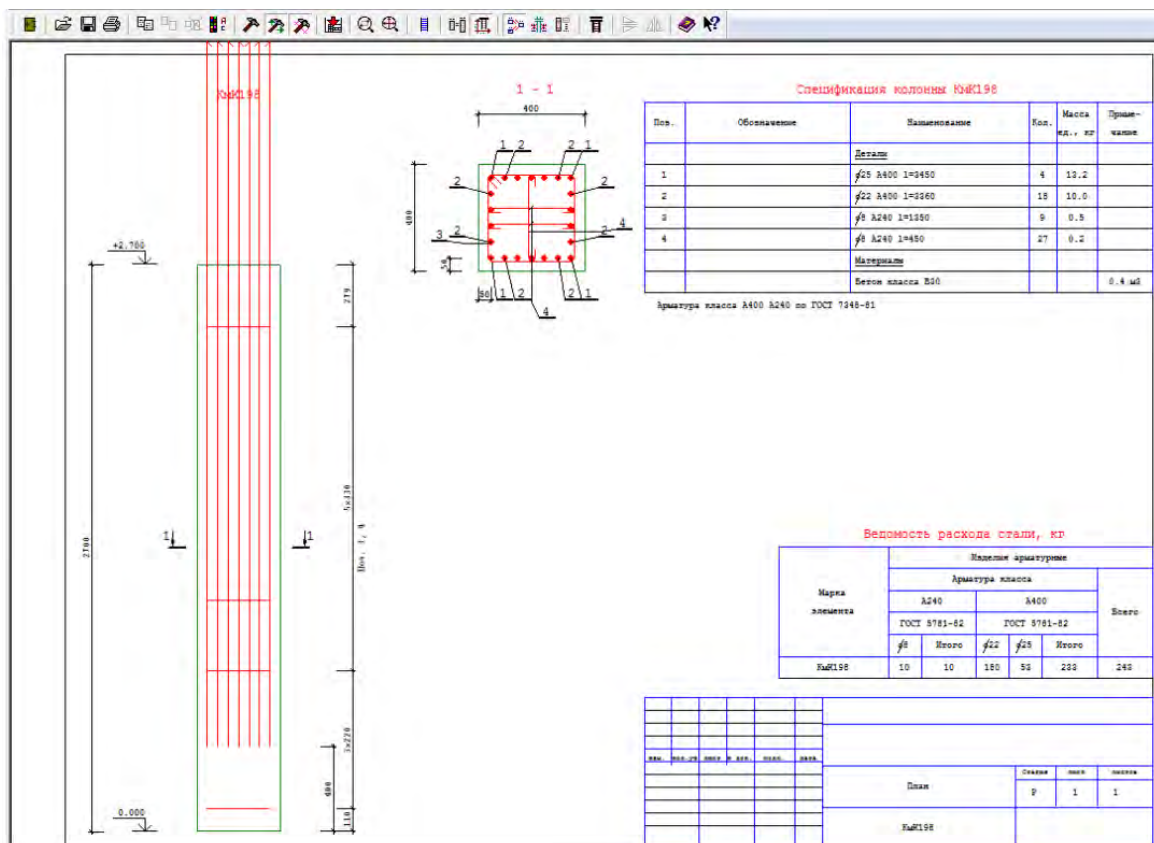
Креслення залізобетонної колони з підібраним армуванням
